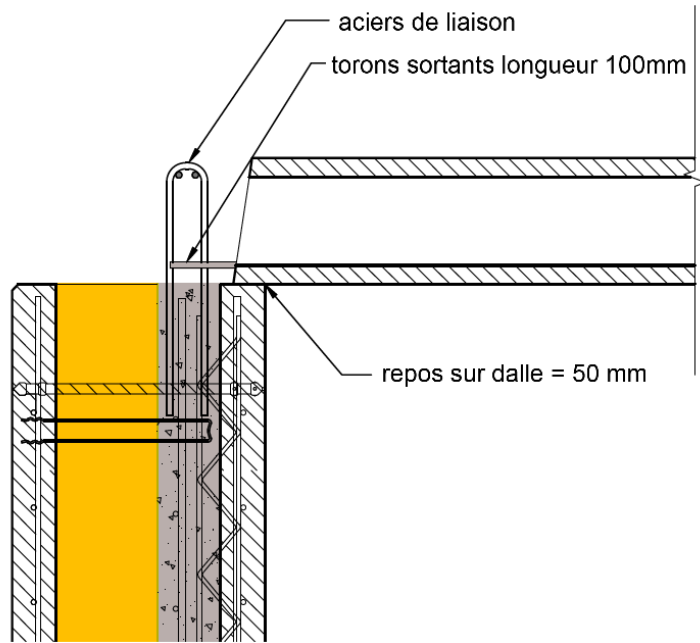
Liaison Mur 2000+ COMFORT avec dalle alvéolaire
